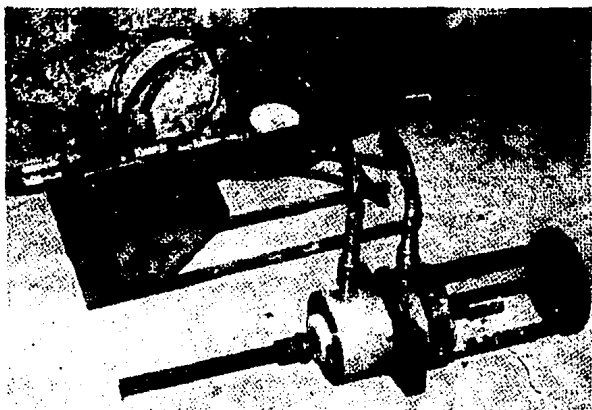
Instrumento hidráulico y bomba para el tensado de anclas.
